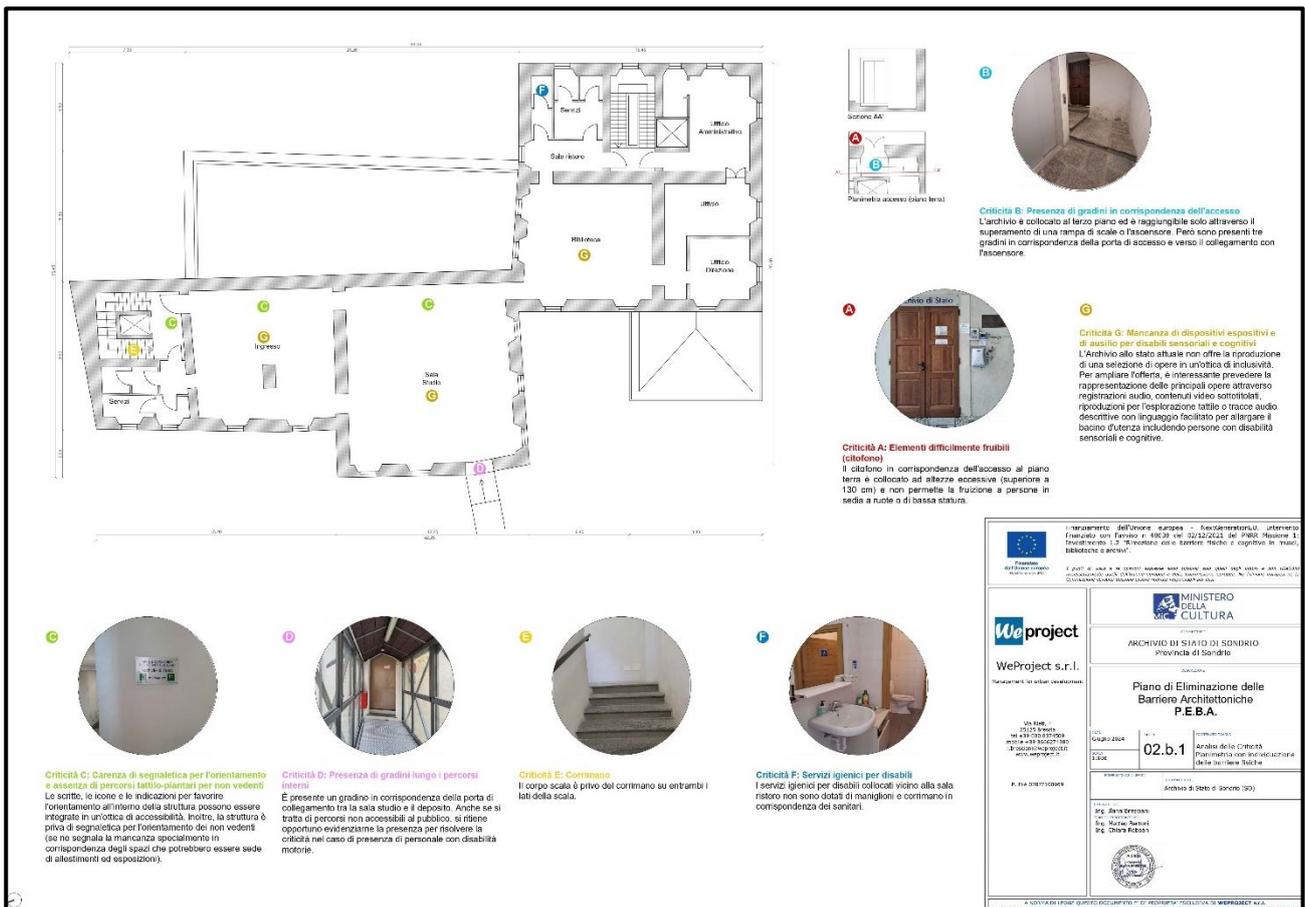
Estratto della planimetria di individuazione delle barriere fisiche (02.b.1\_Analisi delle criticità\_Planimetria con individuazione delle barriere fisiche)
